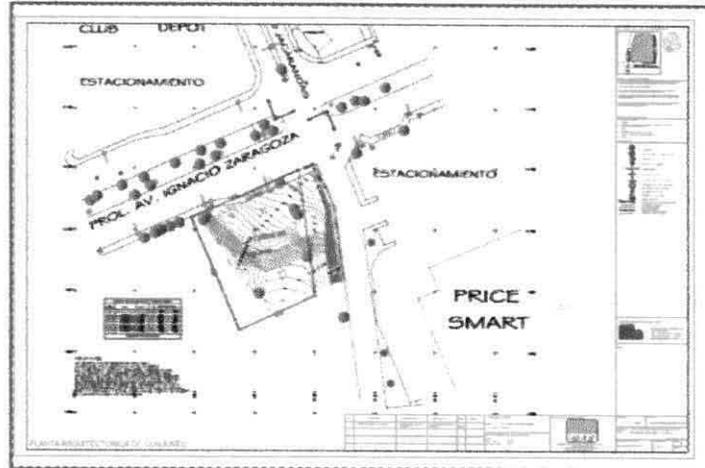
3. Levantamiento topográfico en el sitio del proyecto (Plano Anexo)
